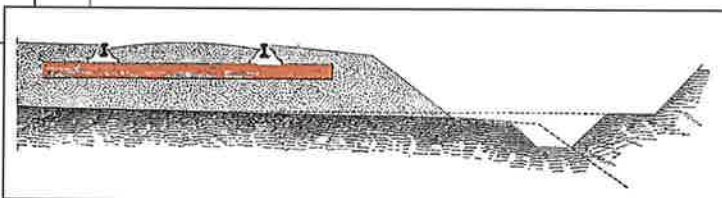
, échelle du plan : 15/1000. Profil des voies anglaises et françaises.
